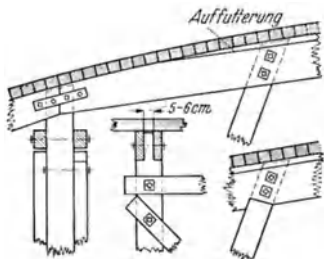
Verbindung der Pfosten und Streben mit zweiteiligen Kranzhölzern in einem Lehrgerüst (nach Mörsch, 10b).
